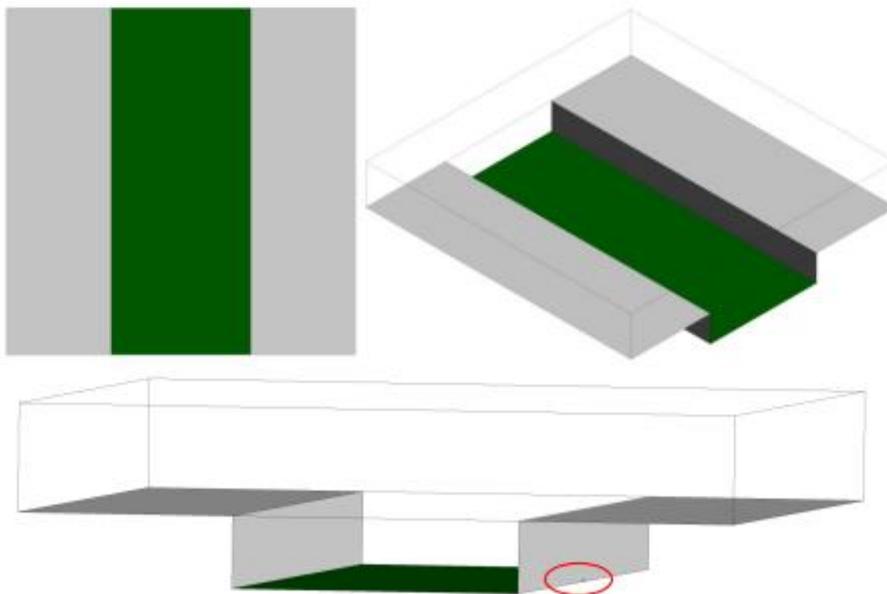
géométrie modélisée : vue de dessus (en haut à gauche), vue isométrique (en haut à droite) et vue de côté (en bas) – grille d'évacuation entourée en rouge
